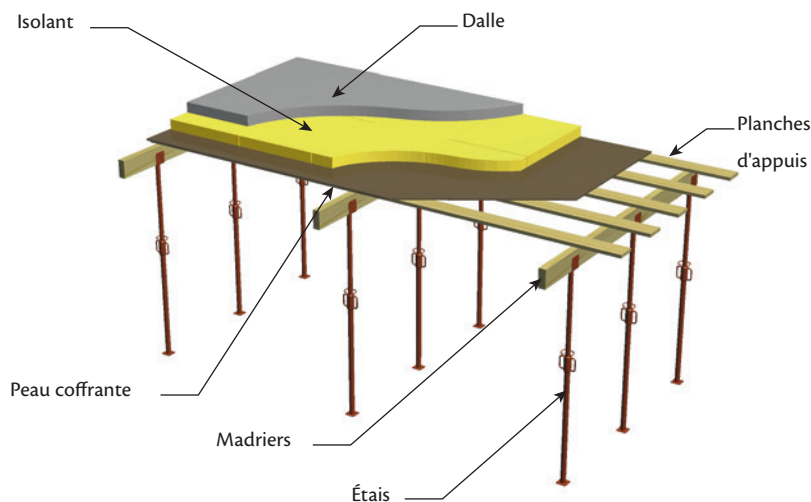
Procédé du fond de coffrage avec panneaux isolants
